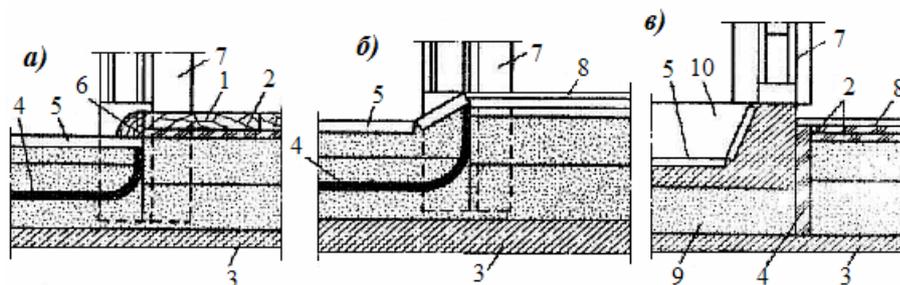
Междуетажные перекрытия в санитарных узлах: а – примыкание паркетного пола к санитарному узлу; б – то же, пола из линолеума; в – то же, к сантехкабине
